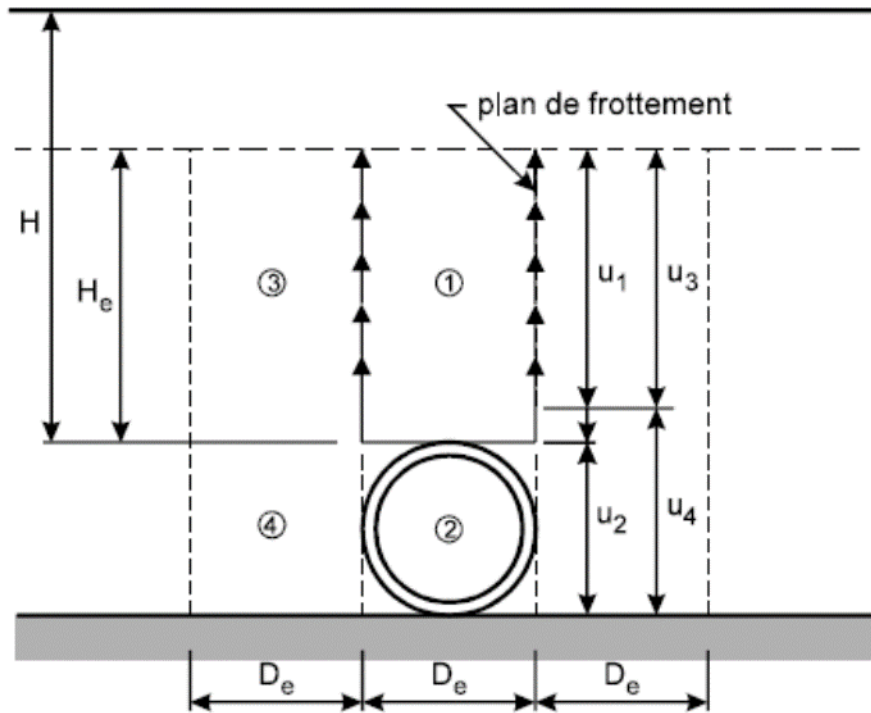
Cas où le plan d'égal tassement est réel ($H > H_e$)
